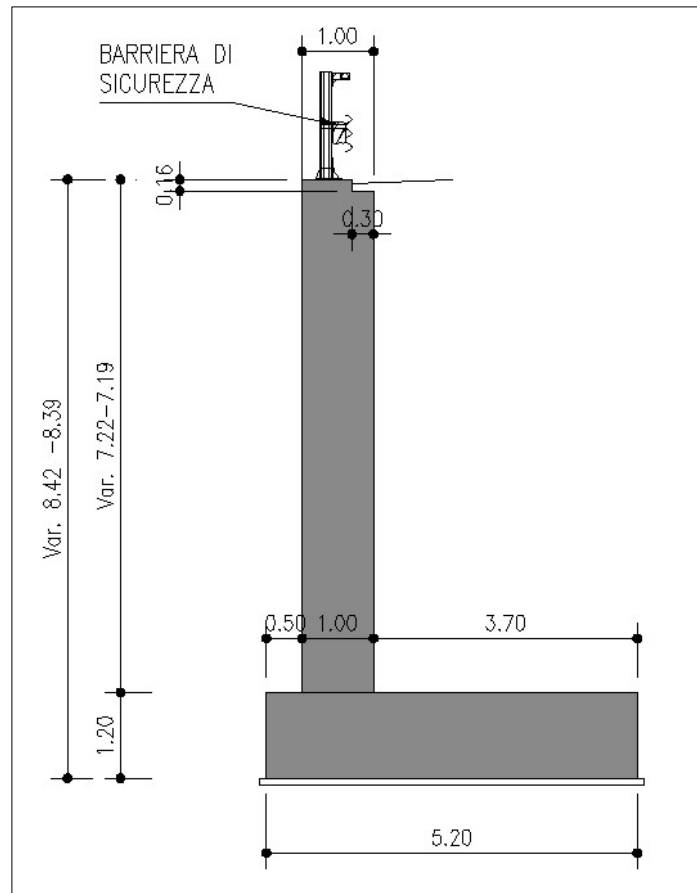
Sezione trasversale del muro andatore lato Rimini – Allargamento Nord
